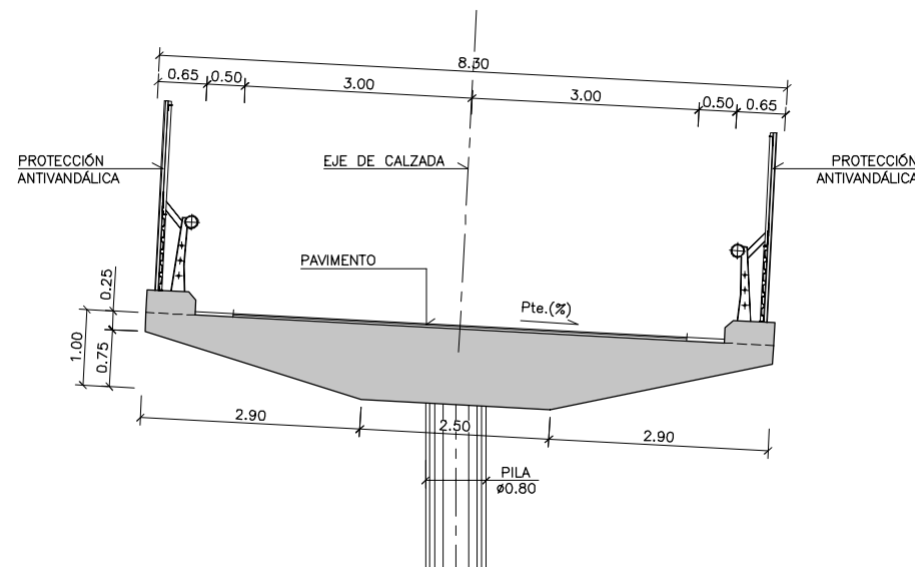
SECCIÓN TIPO PS CAMINO SOBRE FF.CC. P.K. 1+330
